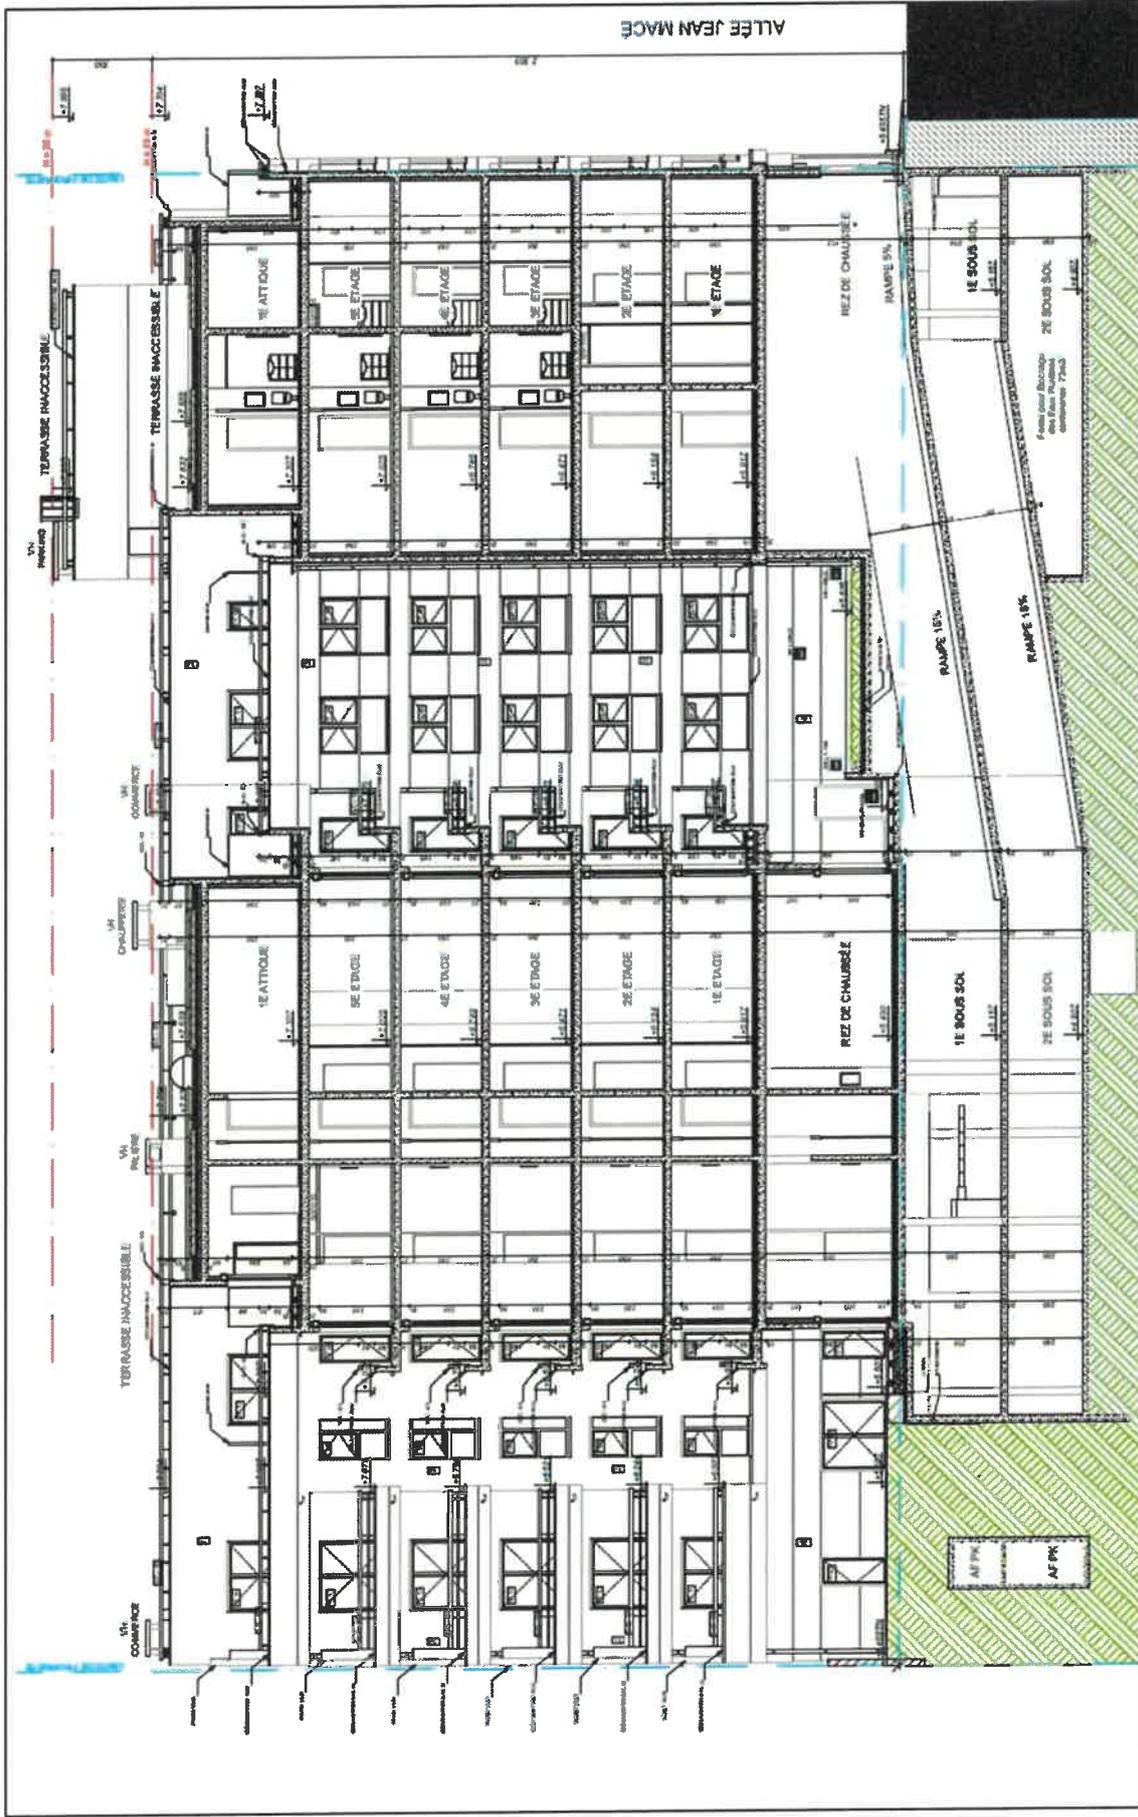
Plan en coupe du projet (Source : Agence GIRAT Architectes)
